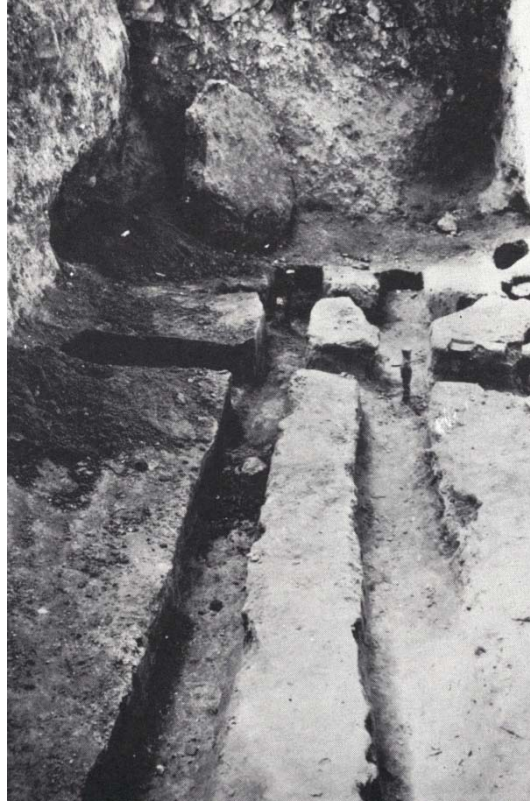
Manisa, Salihli- Kilise E Planı, temel sisteminde ahşap hatıl kullanımı (Buchwald, 1977 f.4).
